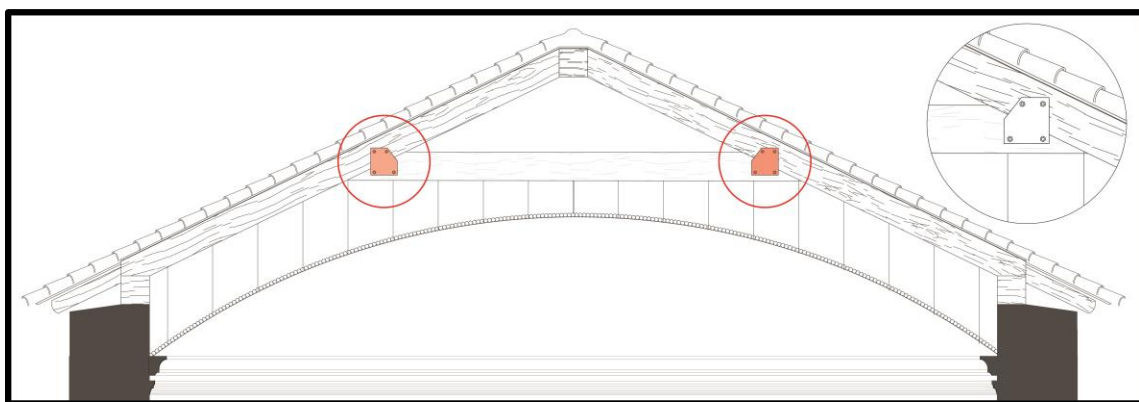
refuerzos estructurales adicionales dentro del sistema estructural de la cubierta.
